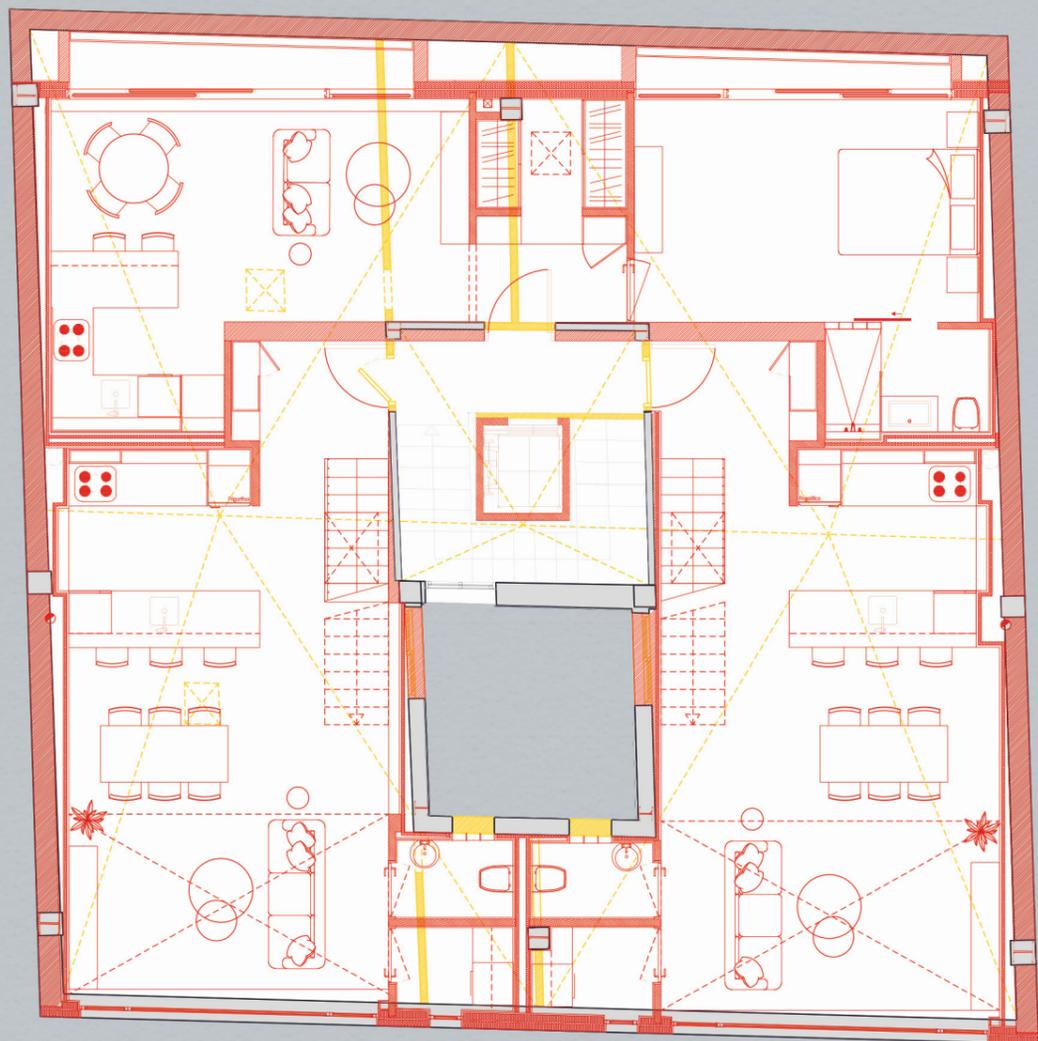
Planta e alçado de vermelhos(construção) e amarelos(demolição)
